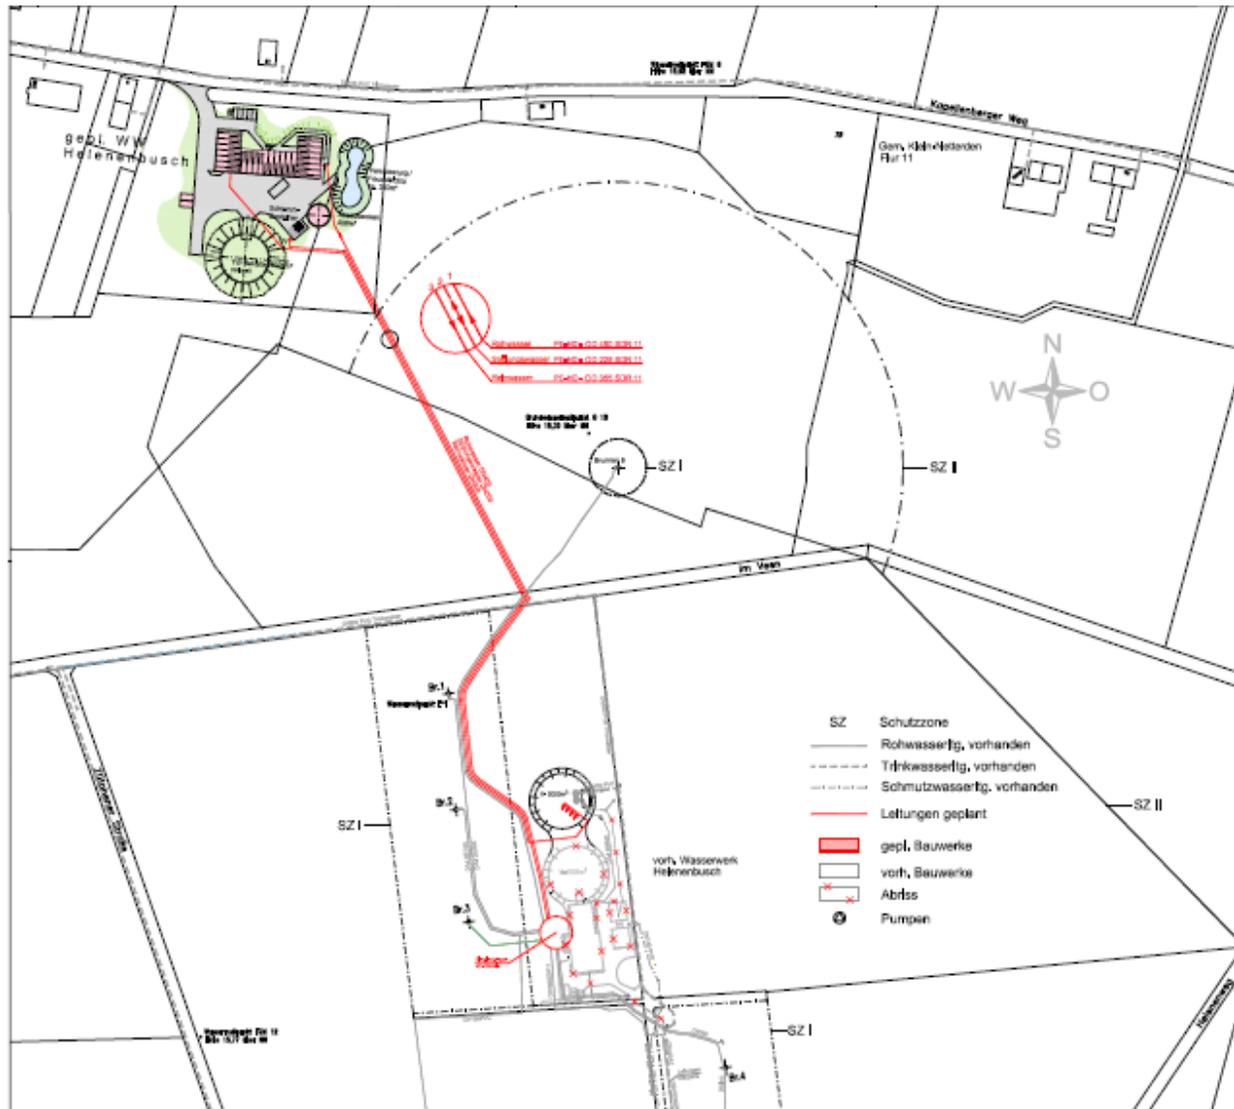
Lageplan mit geplanten (oben) und altem Wasserwerk (unten) sowie den drei Wasserleitung für Roh-, Spülungs- und Reinwasser. Quelle: WETZEL & PARTNER (2013).
